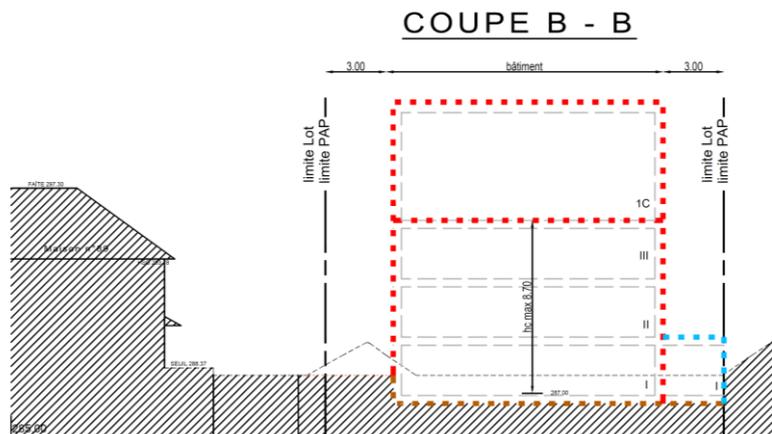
Coupe longitudinale des bâtiments (Source : BEST)
